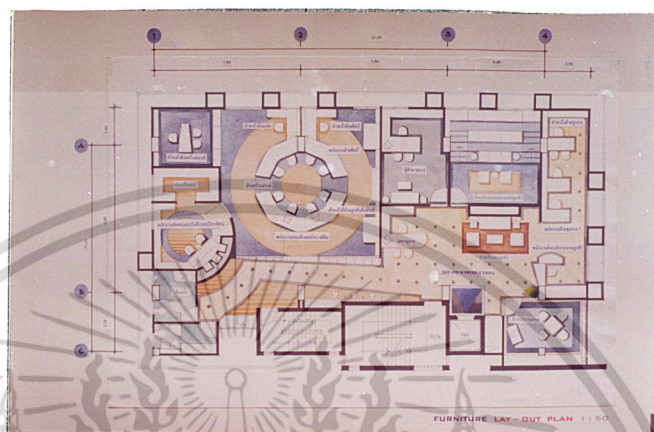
FUNITURE LAY - OUT PLAN 3RD
